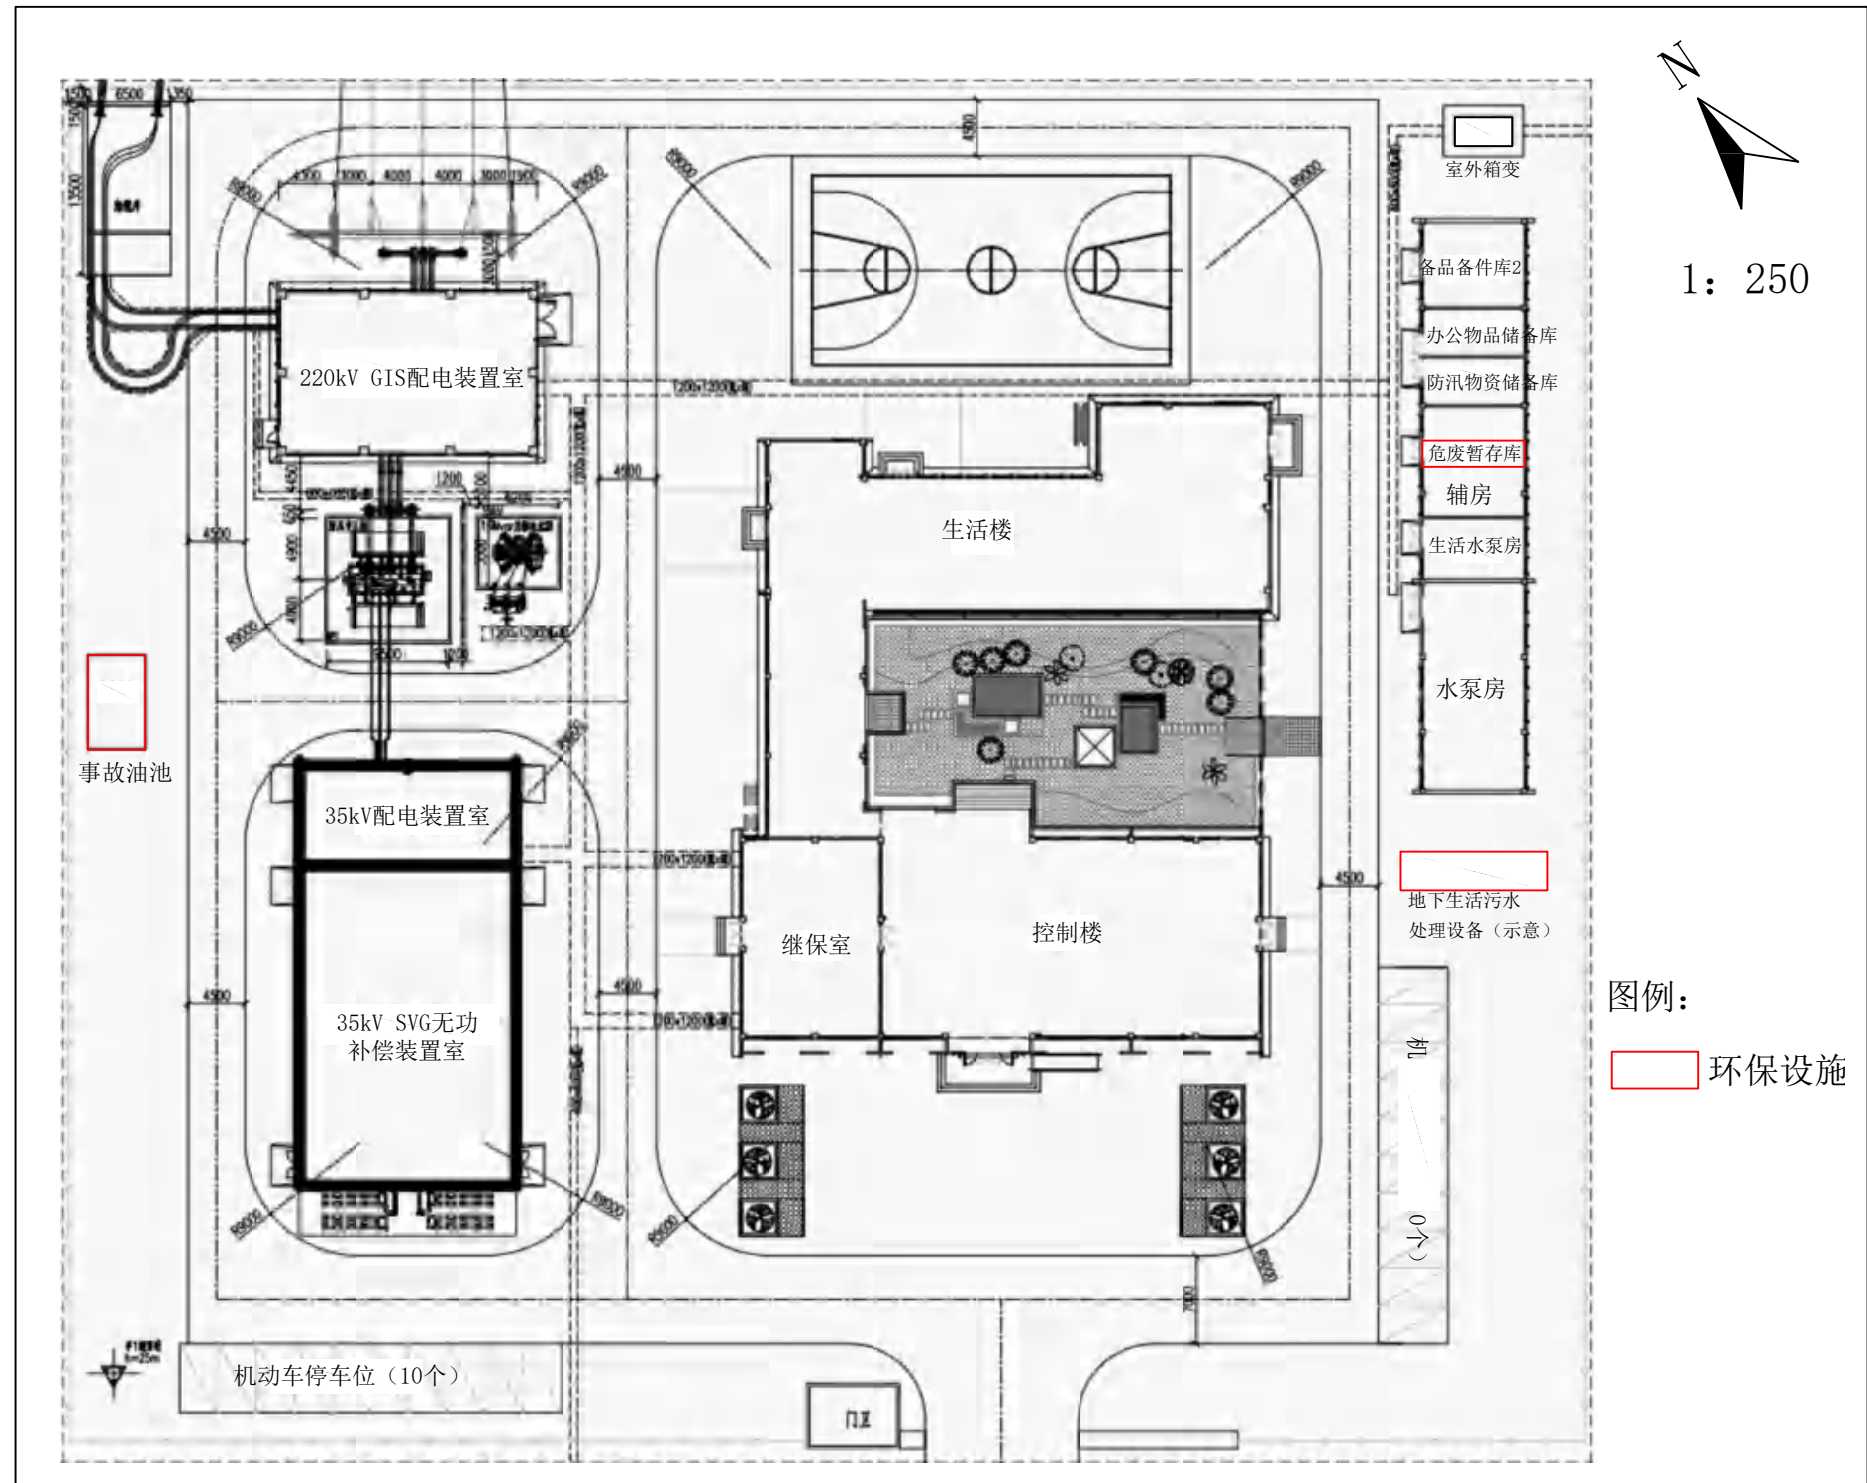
(b) 变动后陆上开关站平面布置图
